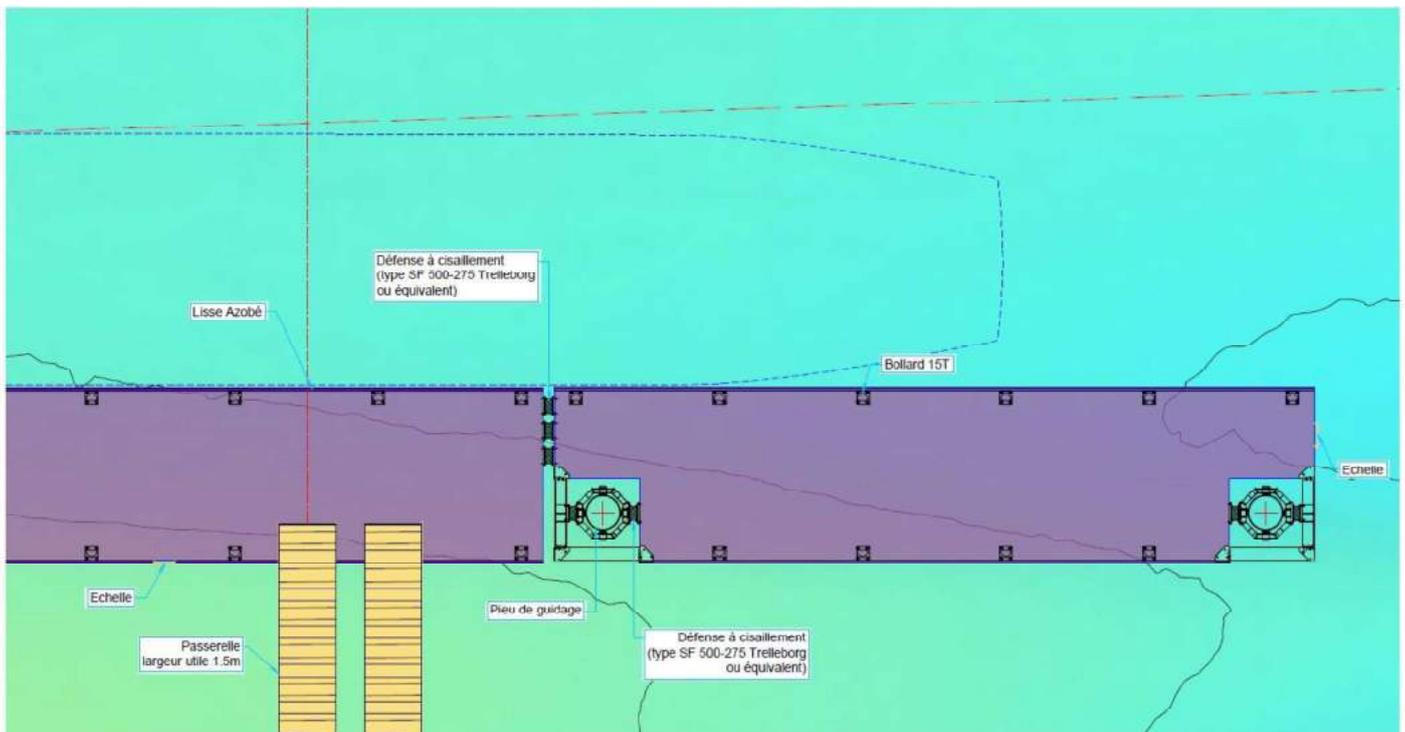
Plan de détail du ponton (Ingérop, AVP, janvier 2023)
